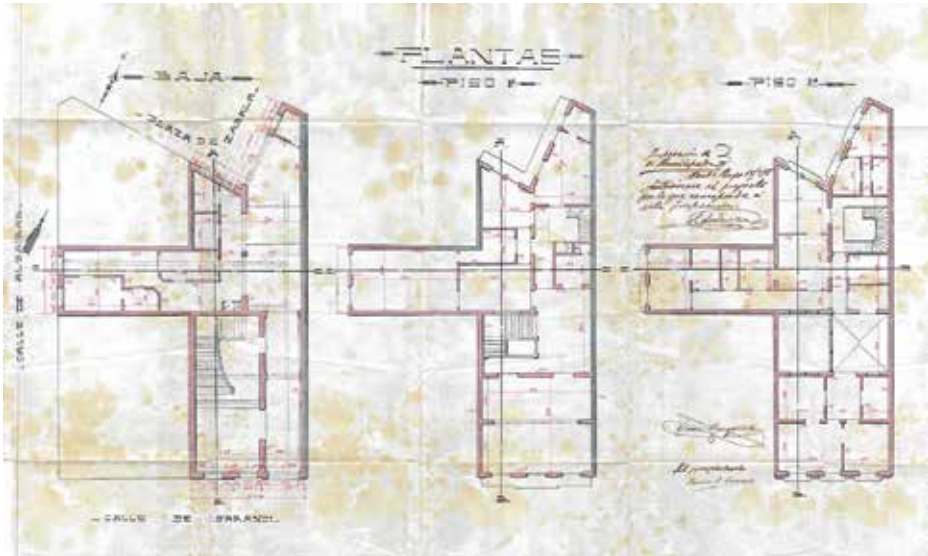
PLANTAS DEL PLANO DE BARAGIOLA DE 1895. DE IZQUIERDA A DERECHA, PLANTA BAJA, PRIMER PISO Y SEGUNDO PISO.
